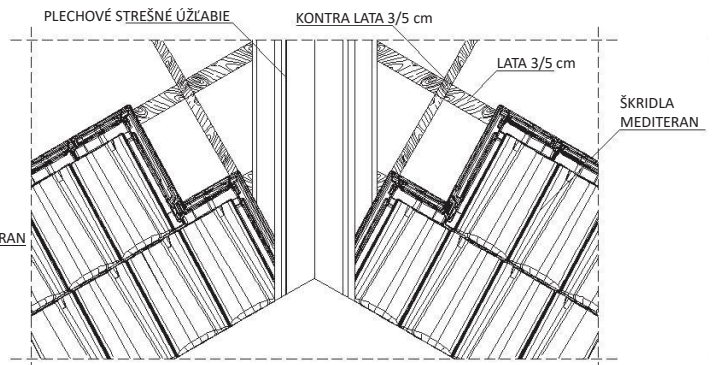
DETAIL STRECHY S PODHLADOVOU KONŠTRUKCIOU
